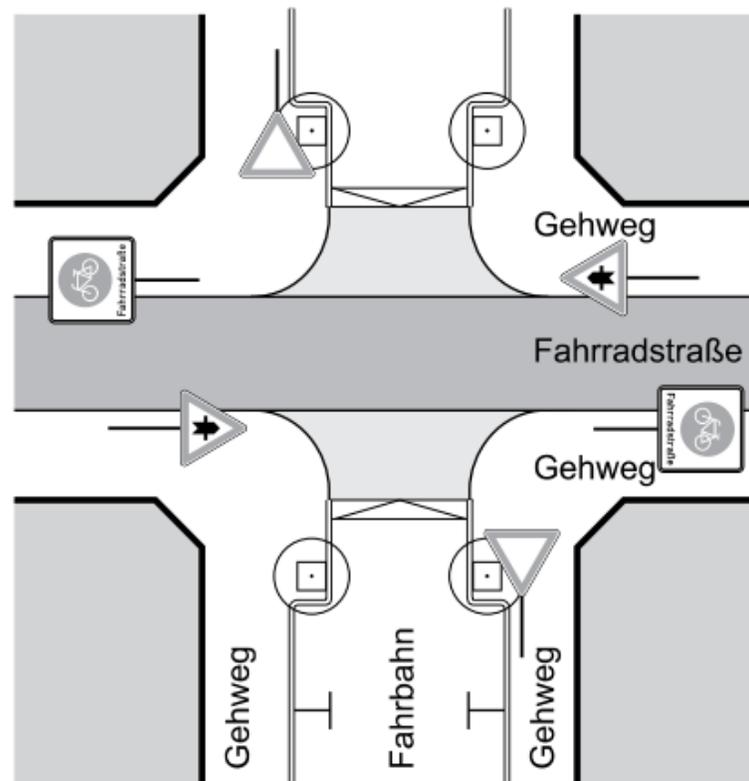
Beispiel für die Kreuzung einer Fahrradstraße mit einer Erschließungsstraße
